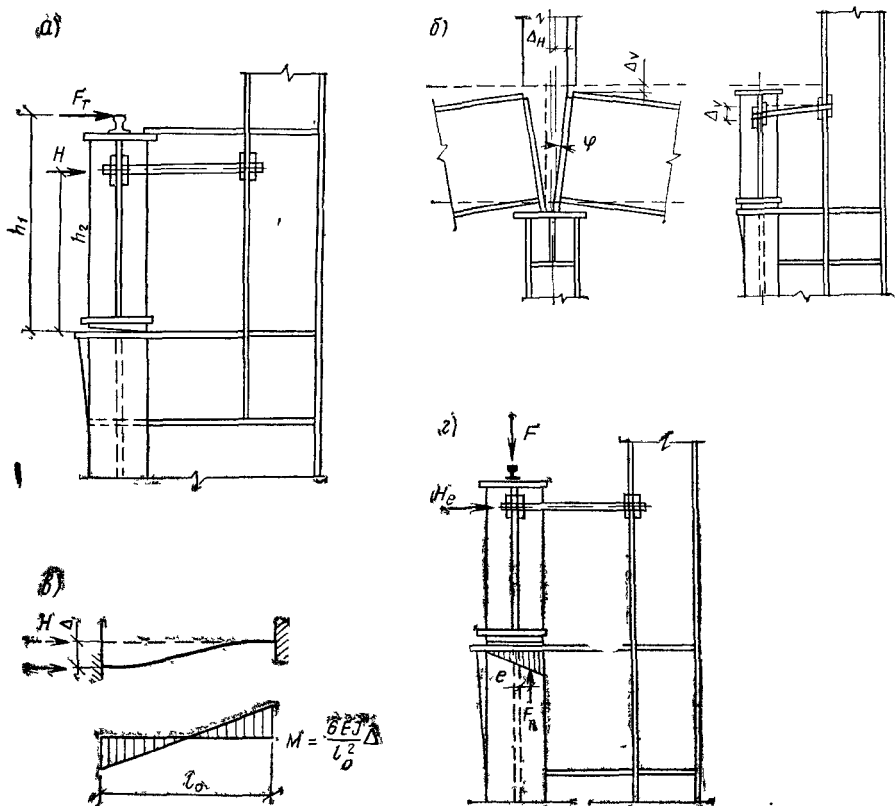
К расчету узла крепления подкрановых балок к колонне
